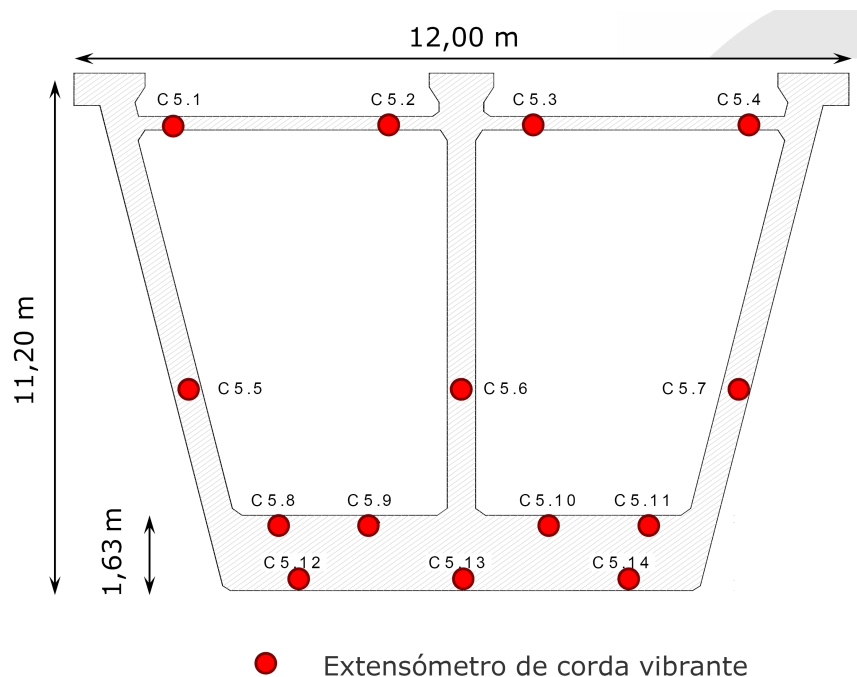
Ponte de S. João: secção instrumentada com extensómetros de corda vibrante
